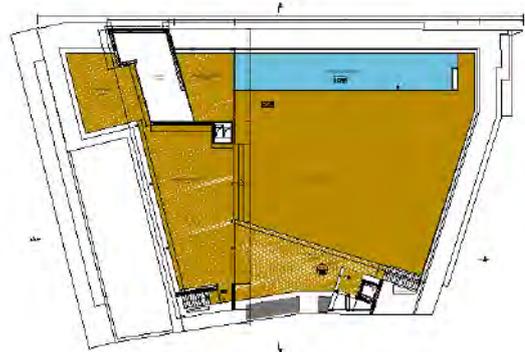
“Edifício Conde Barão” Projeto –Planta do piso 8 (Fonte: Gesturbe, proc. 782/EDI/2016)
